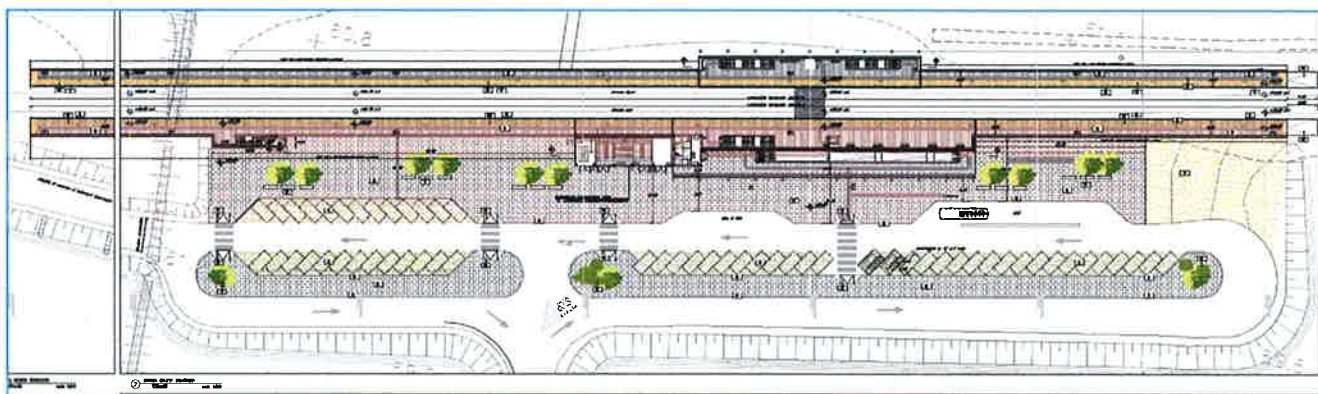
Fermata Solopaca – Planimetria piazzale (Rif. [61])
